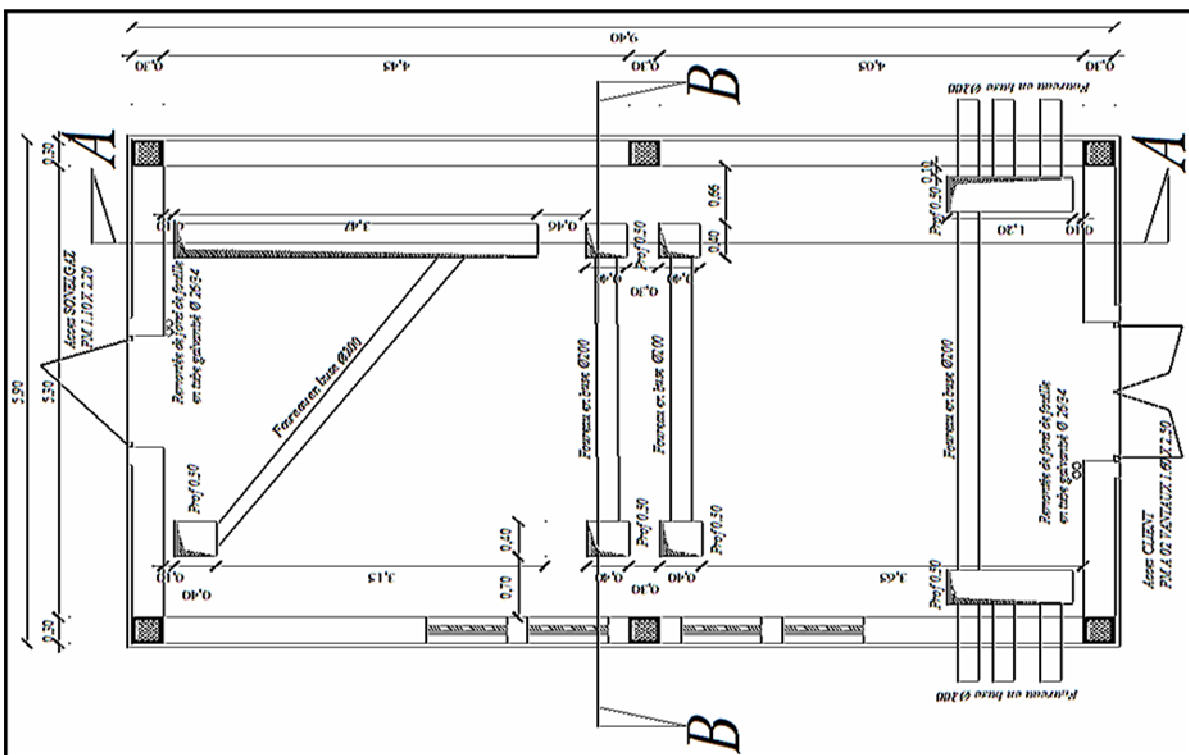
Plan de réservation d'un poste livraison à comptage MT
